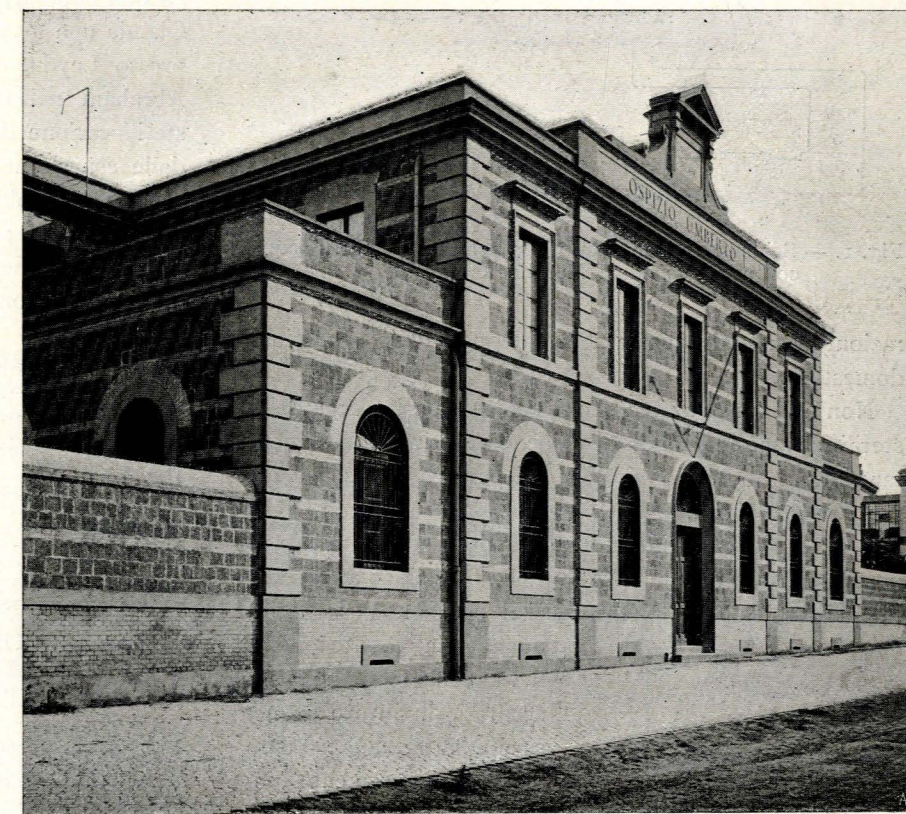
Prospetto del corpo centrale sulla via Santo Stefano Rotondo.
